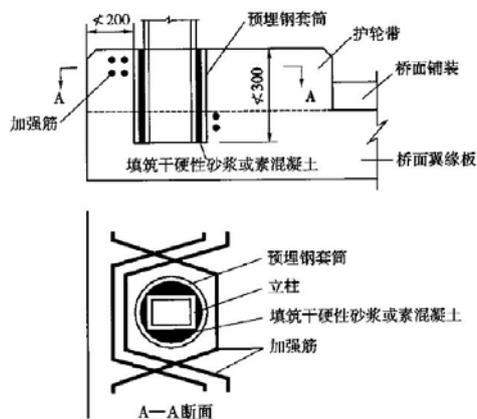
直接埋入式连接方式（尺寸单位：mm）
